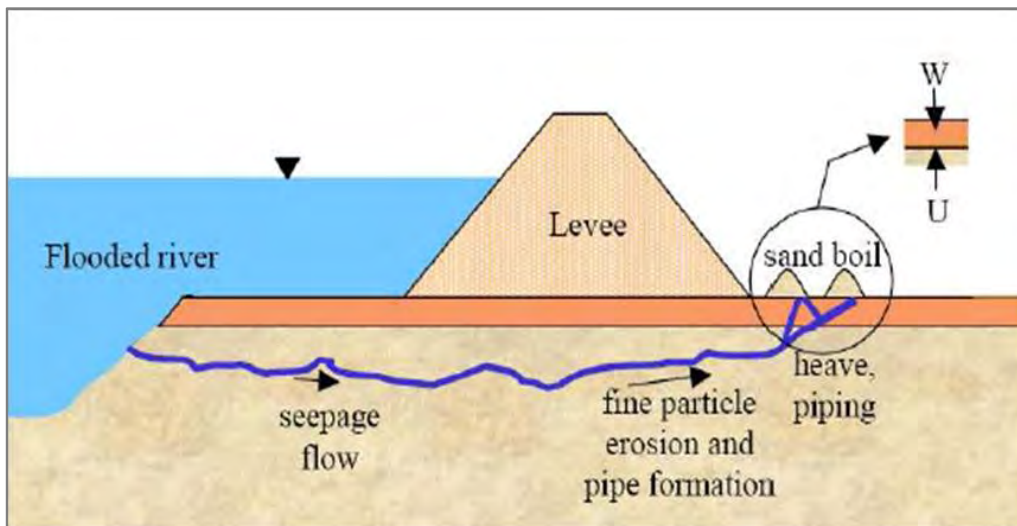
Fenomeno di piping. Modello americano. [Ammerlaan, 2007]
